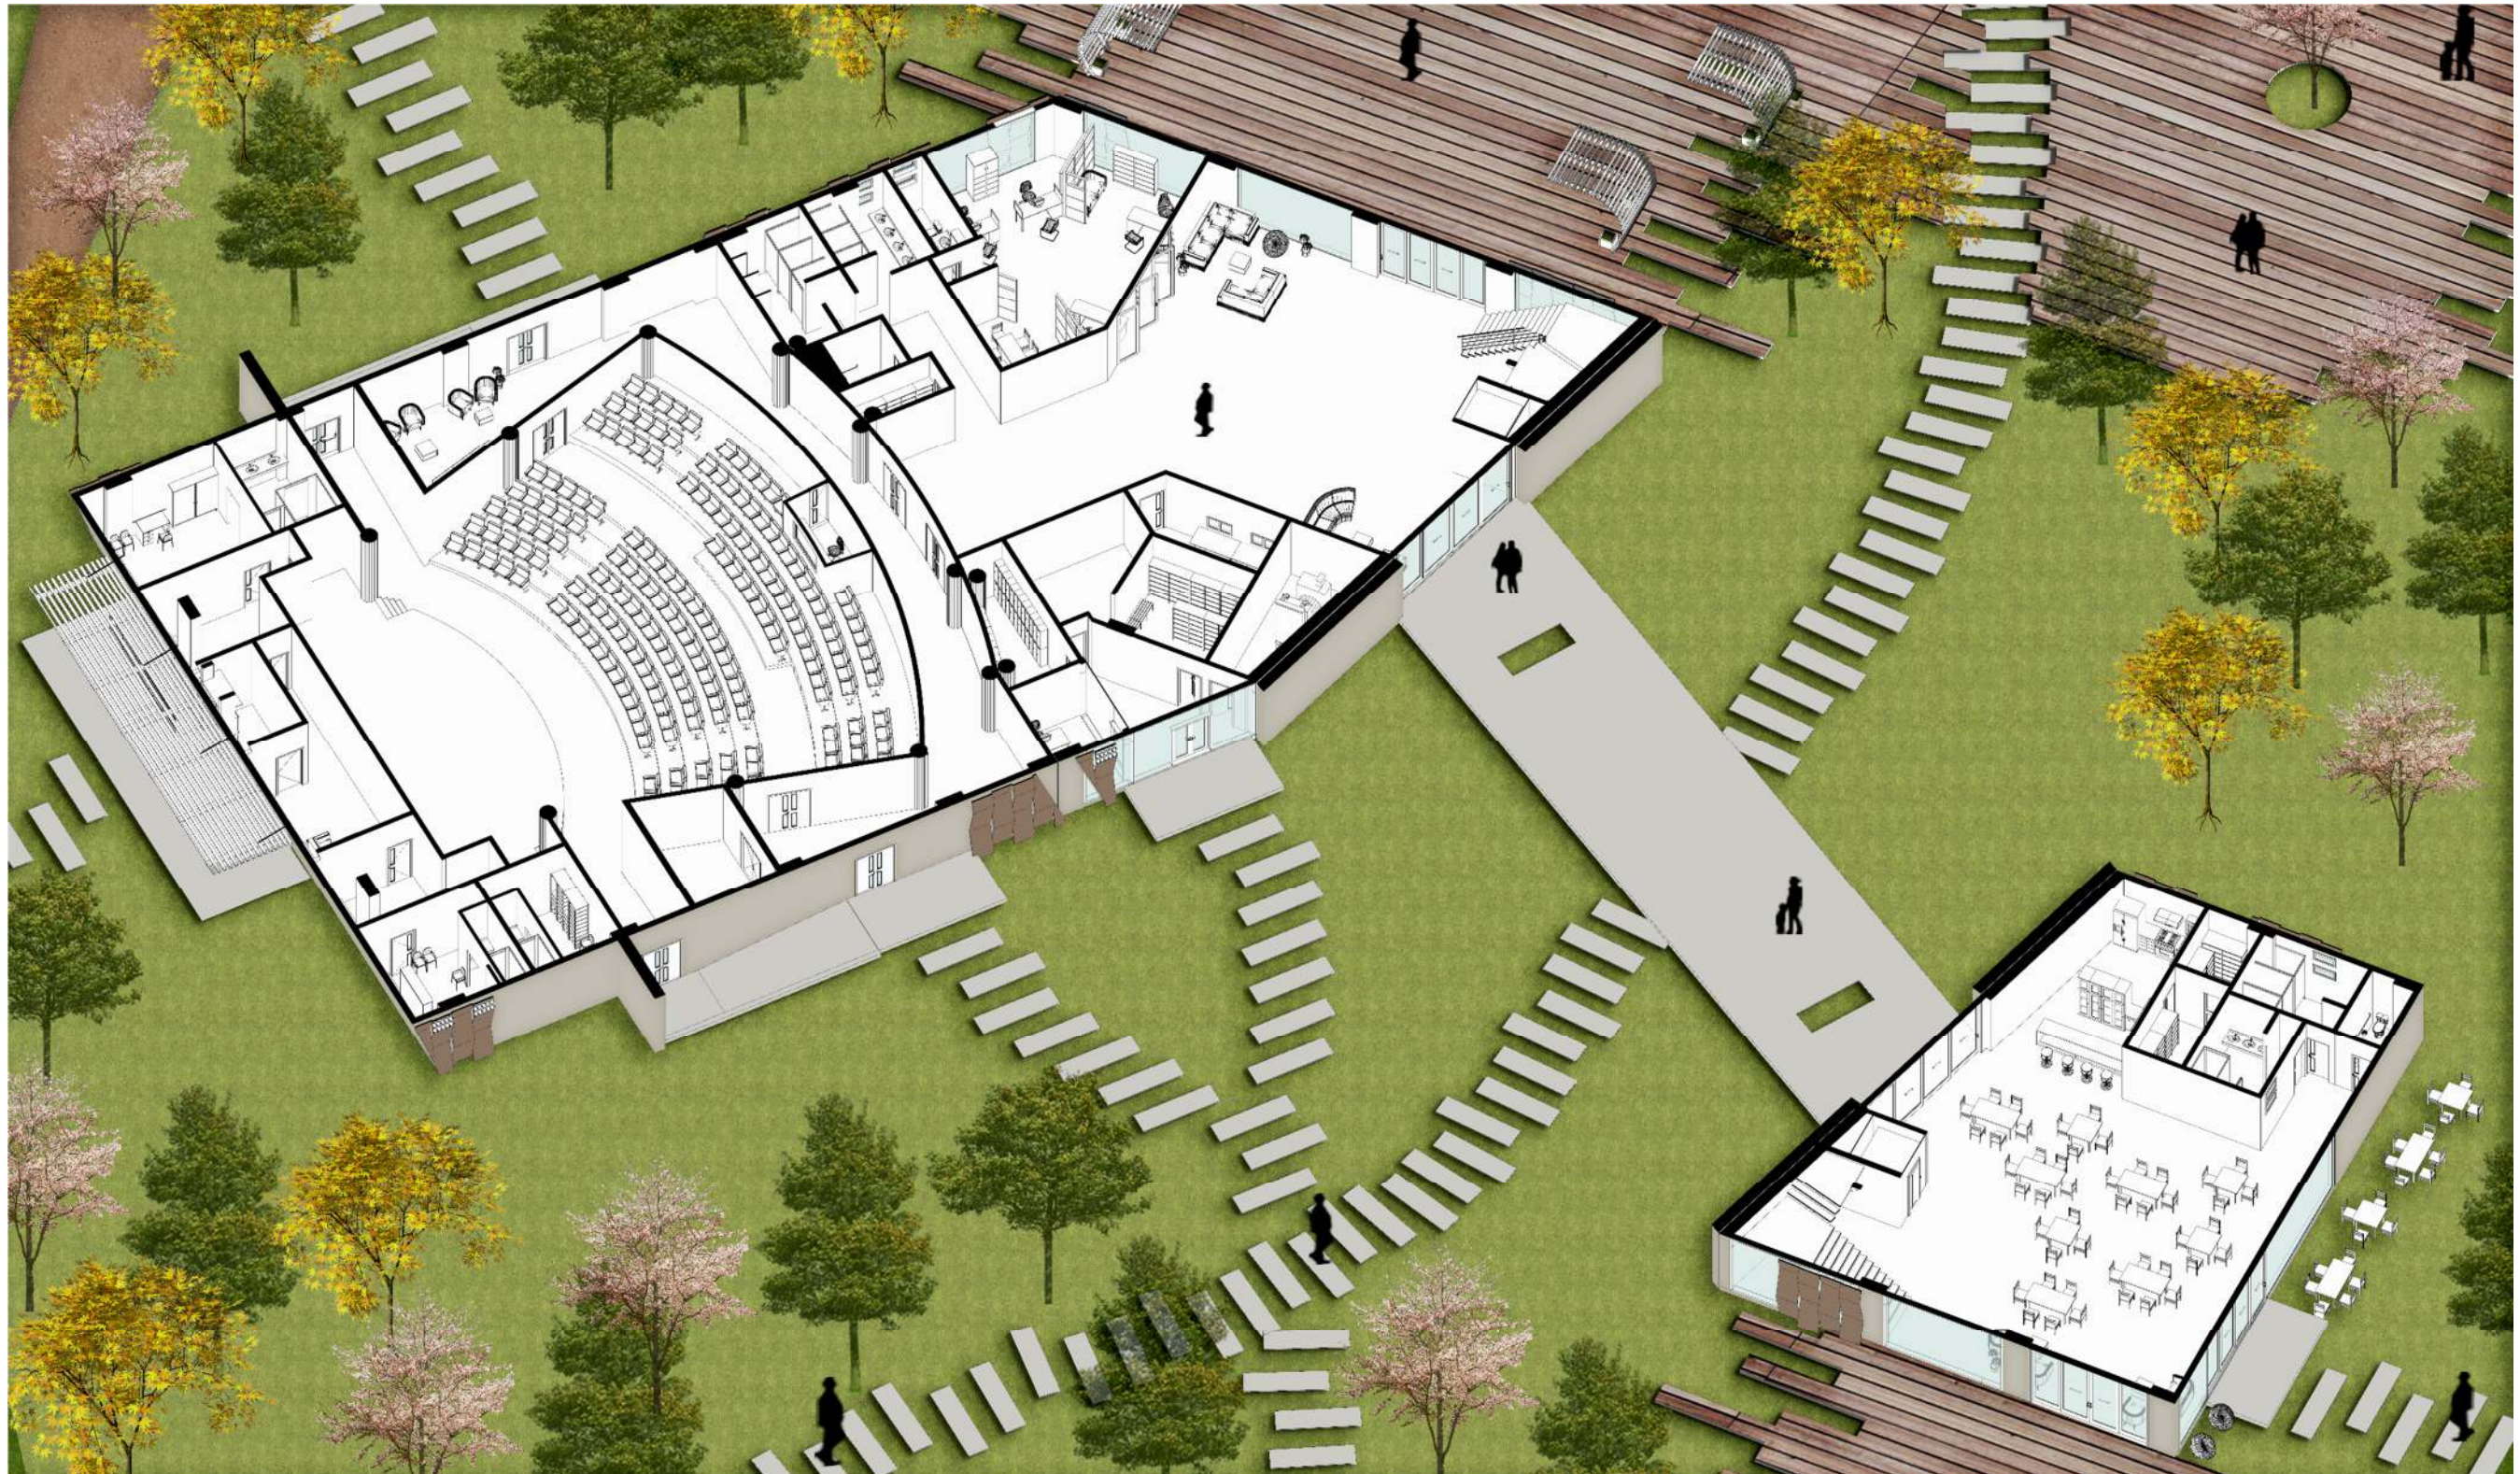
Perspectiva Centro cultural de danza Planta Baja
